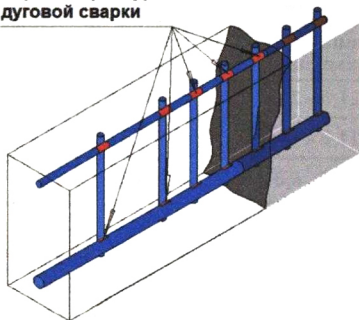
Зоны пережога арматуры в типовых железобетонных перемычках
